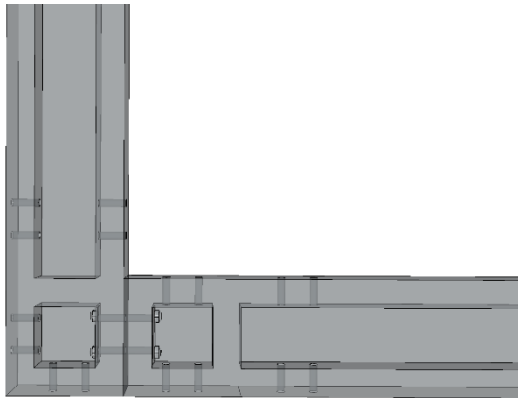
14 Hubungan balok dengan kolom tipe 2 3D
